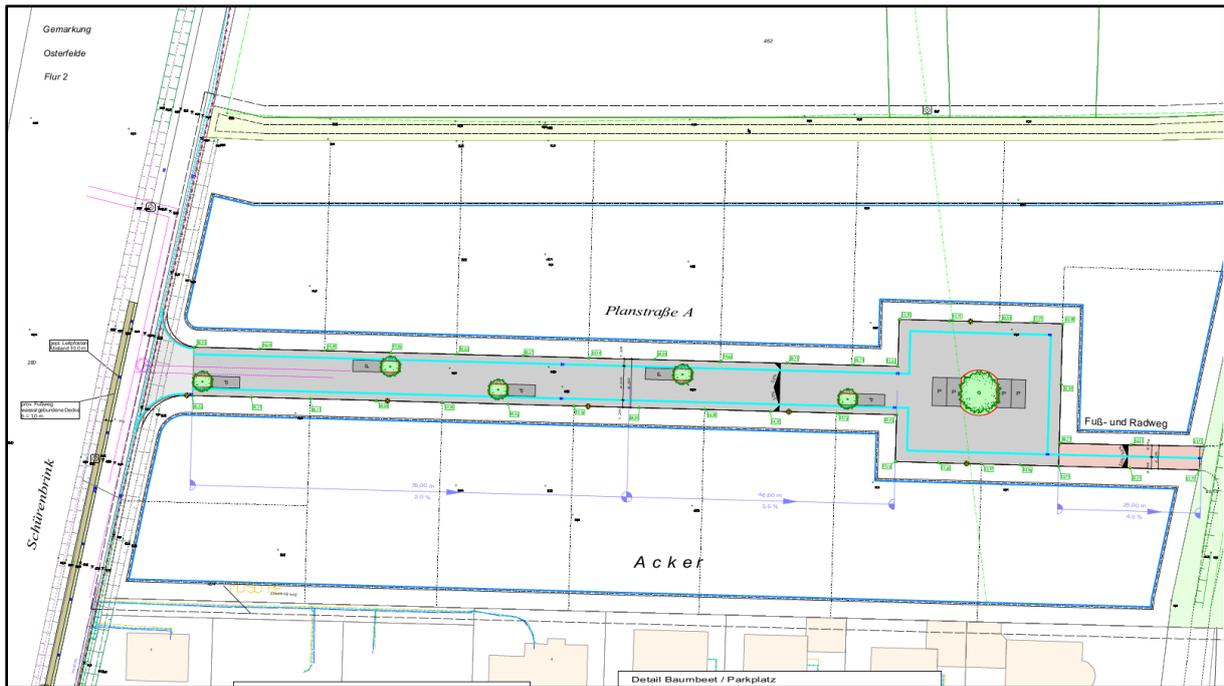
Ausbauhöhenplan zum Baugebiet Hülskamp, Bezugshöhen Straßenplanung (vgl. Anlage 1)
